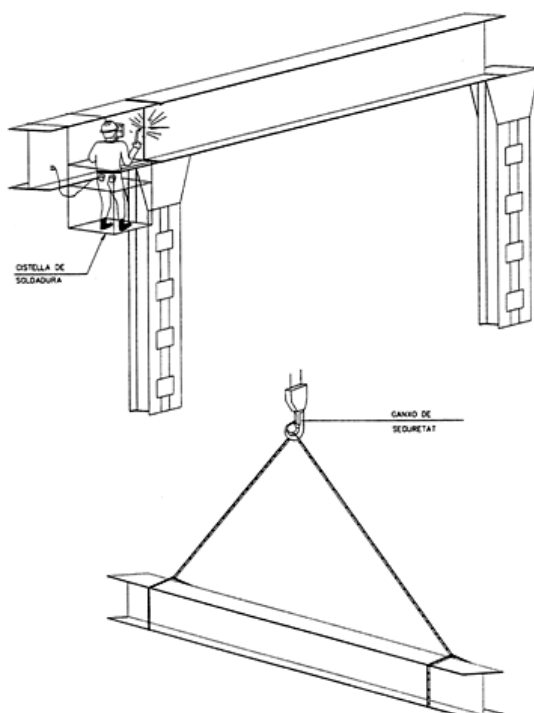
Cistella de soldadura per estructures d'acer
